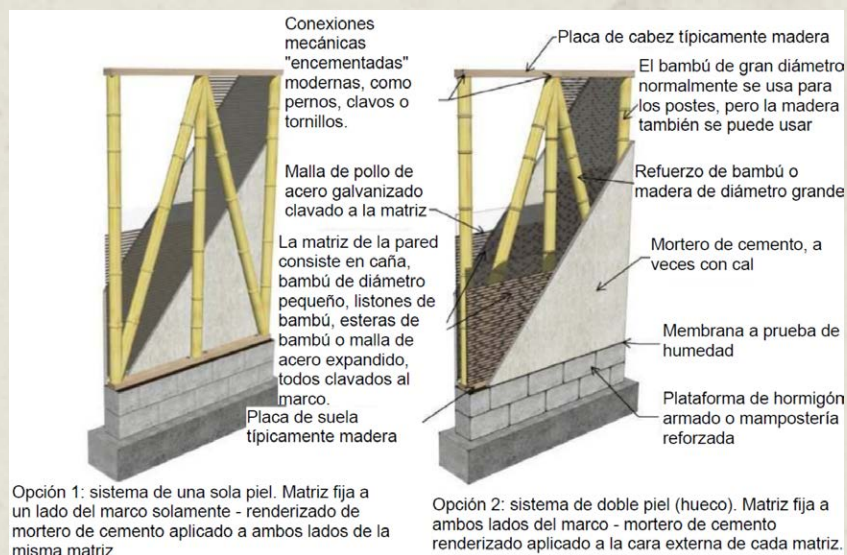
Detalles de muros de corte de viviendas modernas de CBSW.
